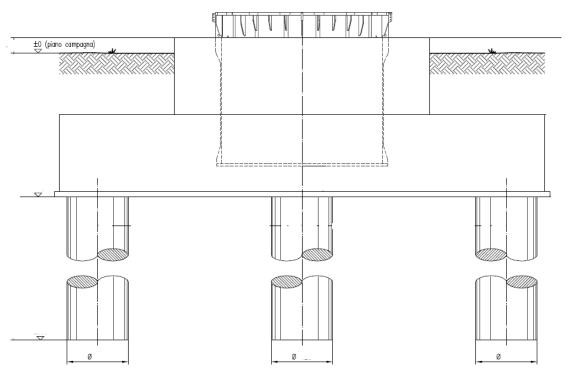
Schema tipo di fondazione su pali fondazione tubolare
